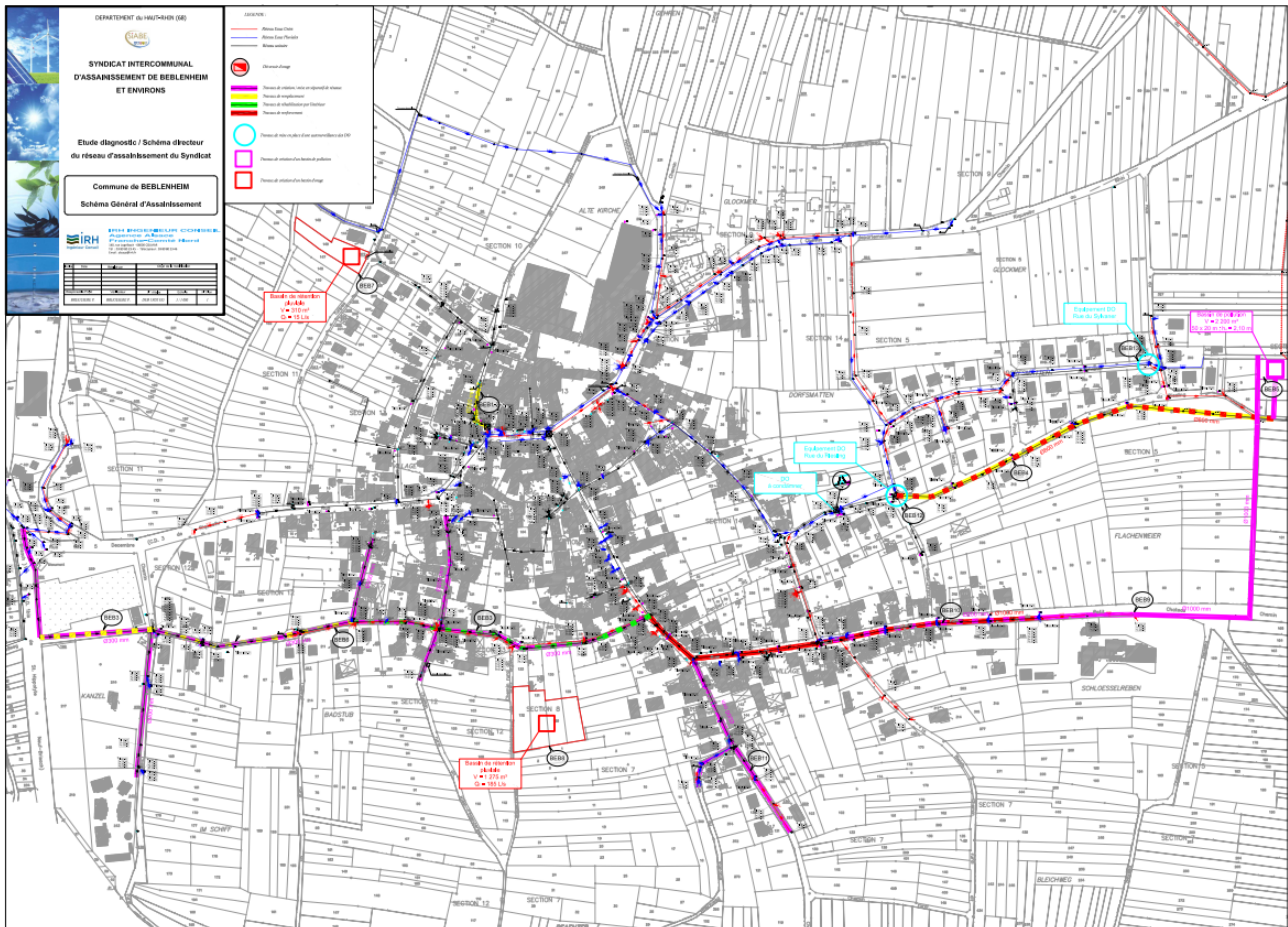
Schéma Général d'Assainissement de la ville de Beblenheim - IRH Ingénieur conseil
